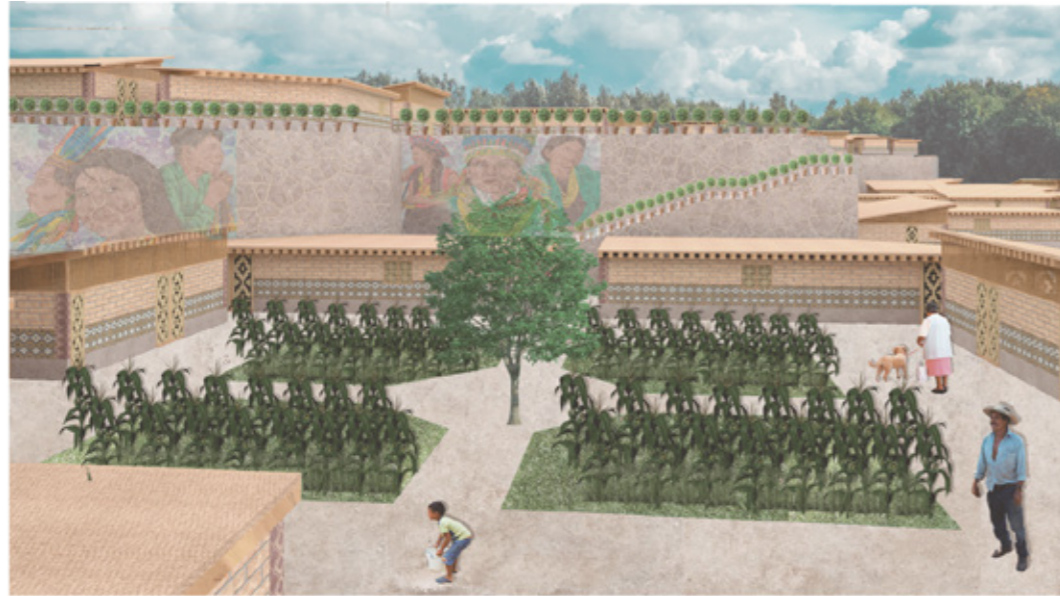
Fachada de las viviendas del Proyecto Reserva Kiwe. Fuente: Imagen: Montaña, S.
